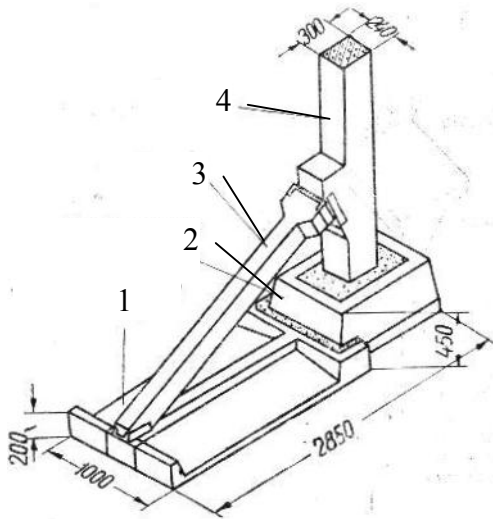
Фундаменти торцевих стін збір-ного залізобетонного зерноскладу 1956 р: 1–навантажувальна плита; 2– фундаментний стакан; 3 – розкіс; 4– колона.
